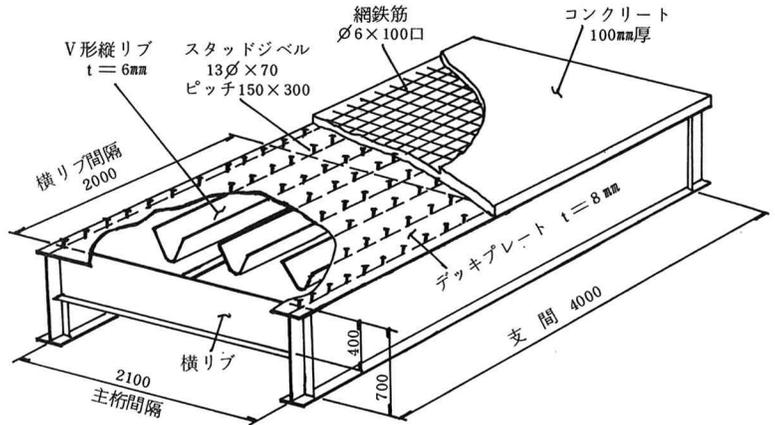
コンクリート合成鋼床版プレートガーダー橋の構造
